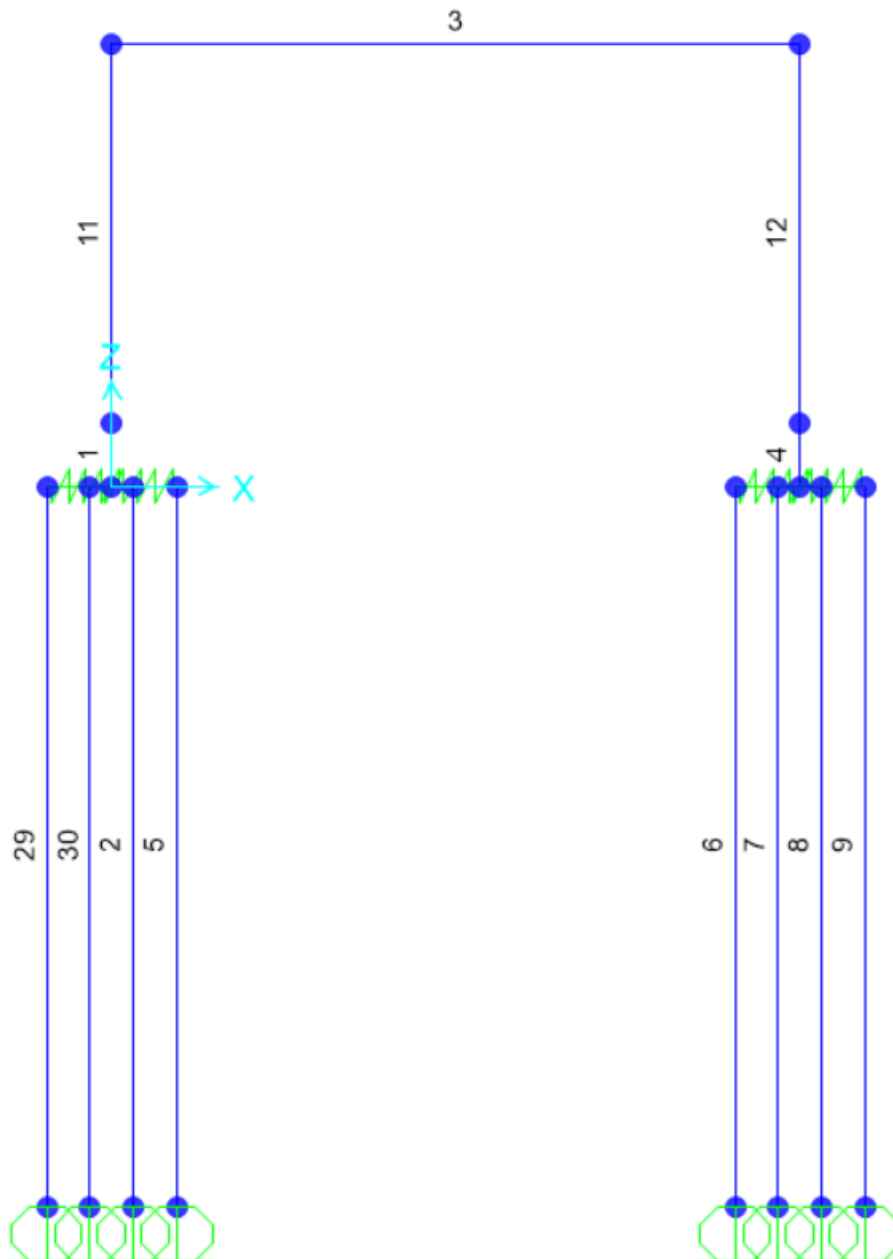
Numerazione degli elementi strutturali tipo beam
